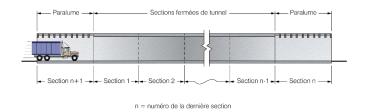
Sectionnement d'un tunnel avec paralumes
